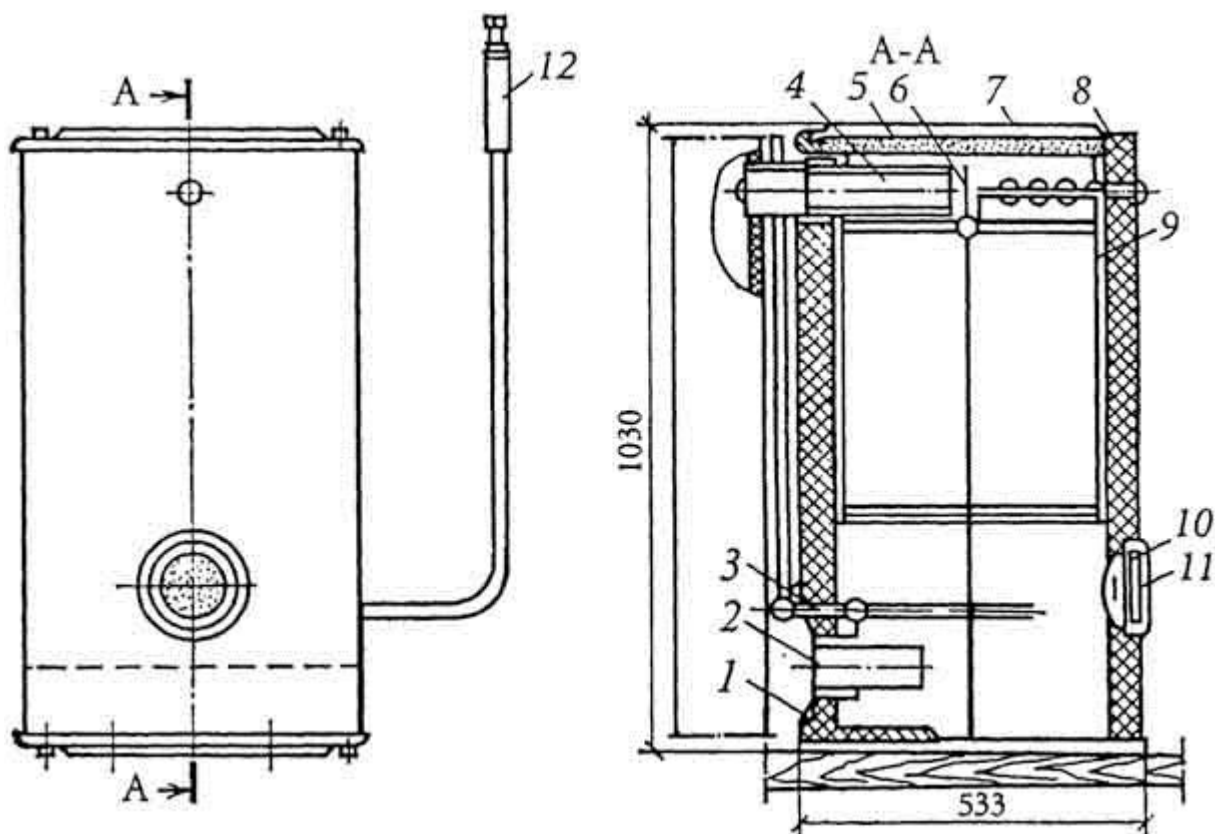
Отопительная газовая печь заводского изготовления: 1 - корпус печи; 2 - поддувало; 3 - горелка; 4 - выходной патрубок; 5 - тепловая изоляция из шлаковаты; 6 - заслонка; 7 - крышка; 8 - муфта; 9 - металлическая полая камера; 10 - съемная оправа; 11 - смотровое стекло; 12 - терморегулятор
